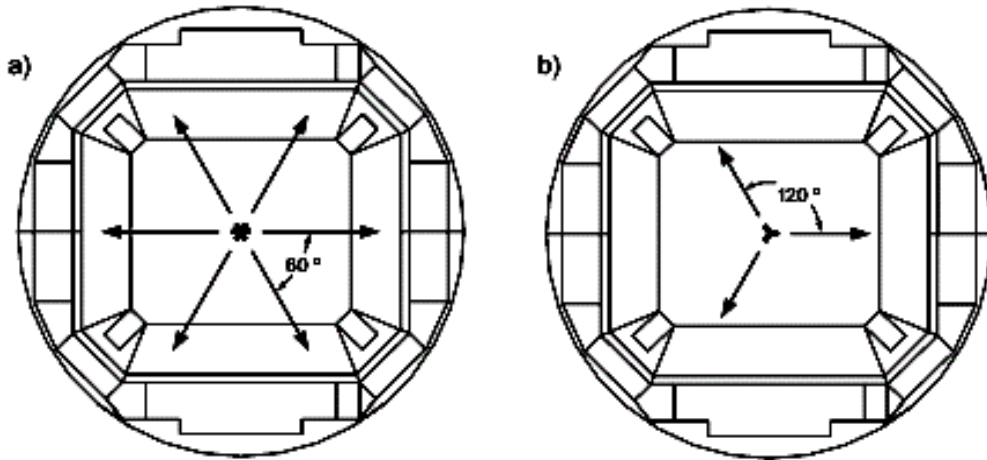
Pabellón Polideportivo de Zurbano: orientación de las cajas acústicas destinadas a sonorizar: a) las zonas de público; b) la pista de juego, vista en planta, (Carrión Isbert A., 1998, p.163).
